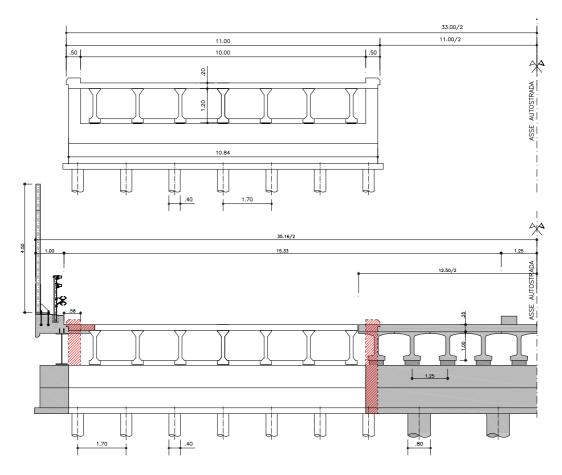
Adeguamento in progetto dell'attraversamento del canale Acque Alte
